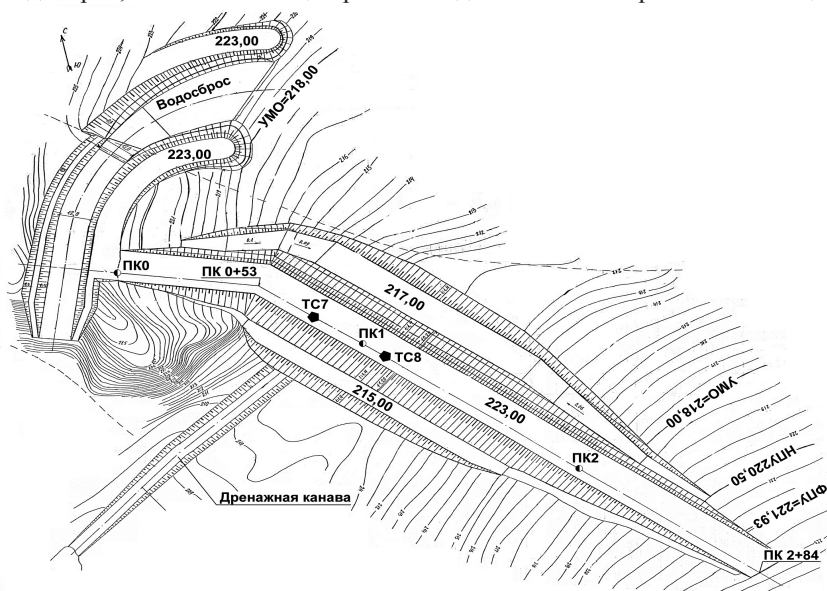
Генплан гидроузла на ручье Уэся-Лиендокит
